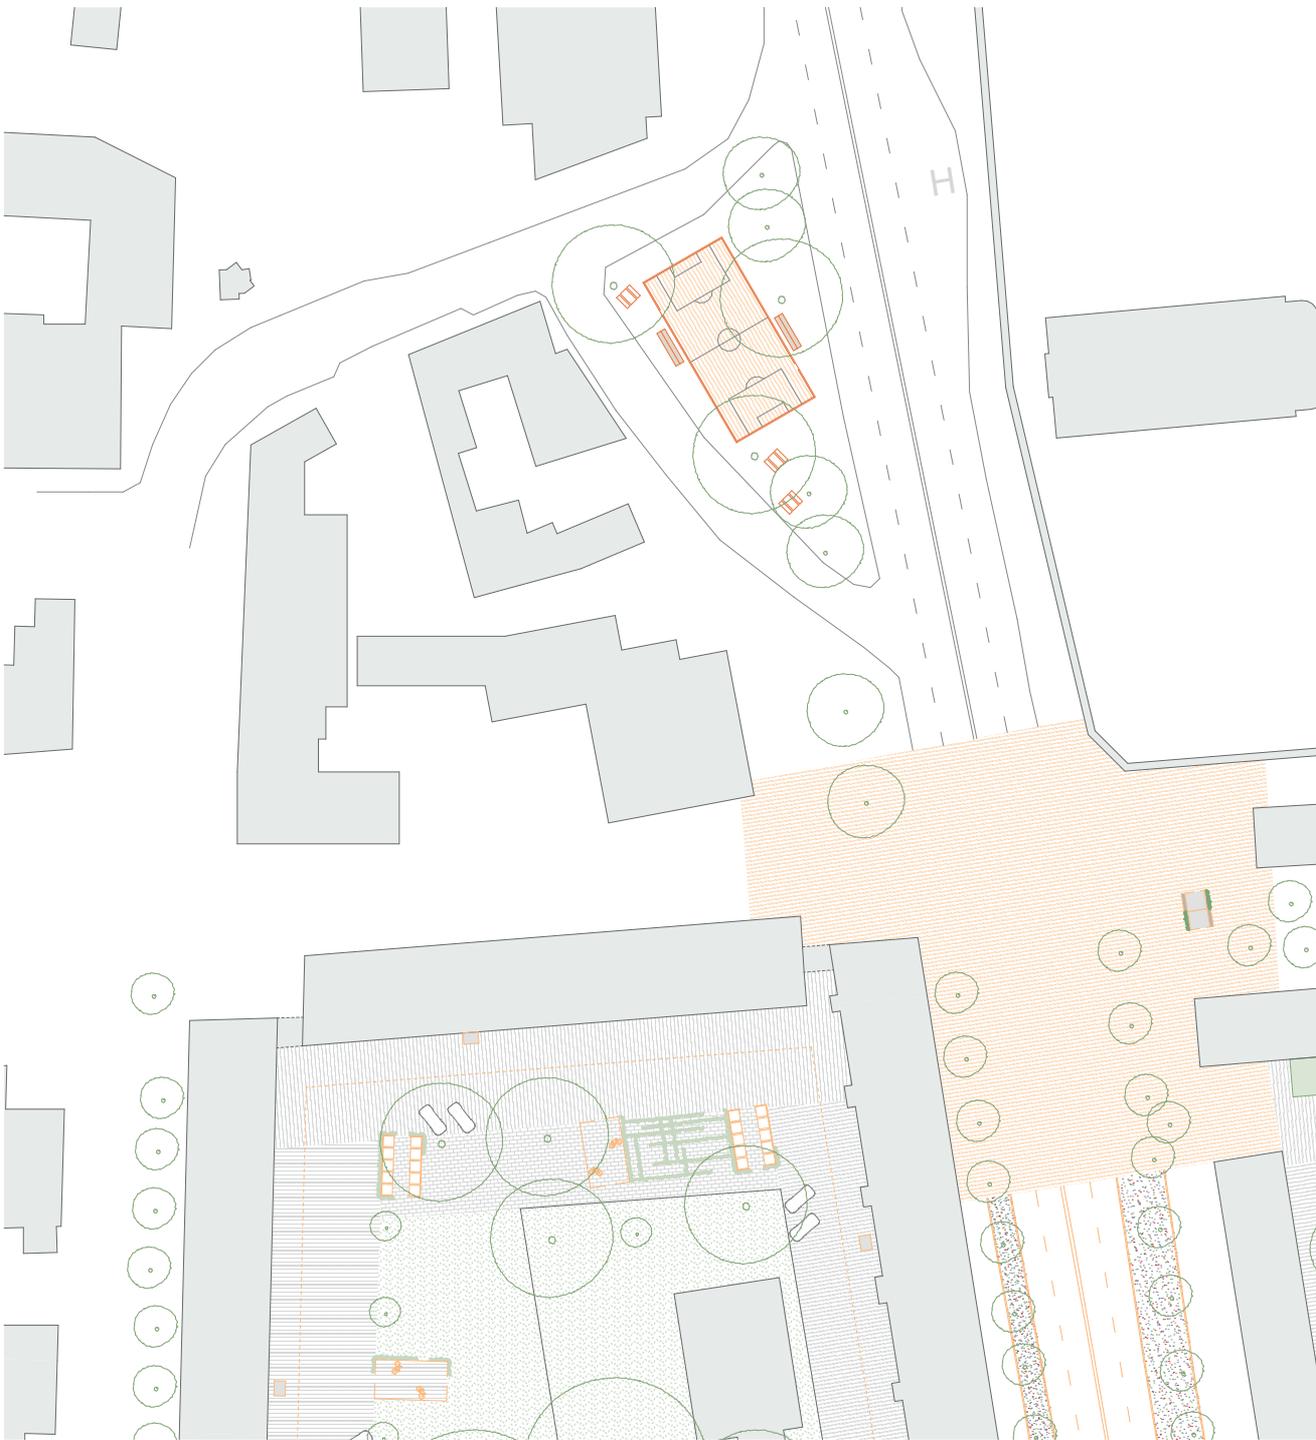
Grundriss öffentlicher Ballspielkäfig M 1:1000
